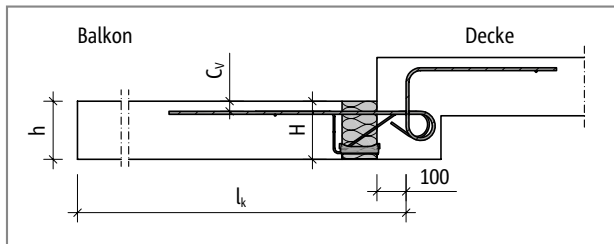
Schöck Isokorb® Typ KXT-HV: Statisches System
